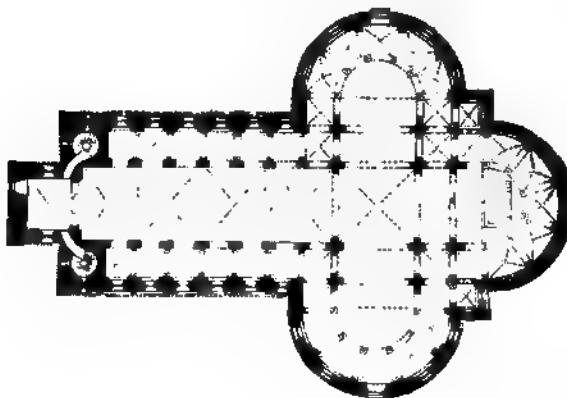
Grundriss von St. Marien auf dem Kapitol zu Köln
